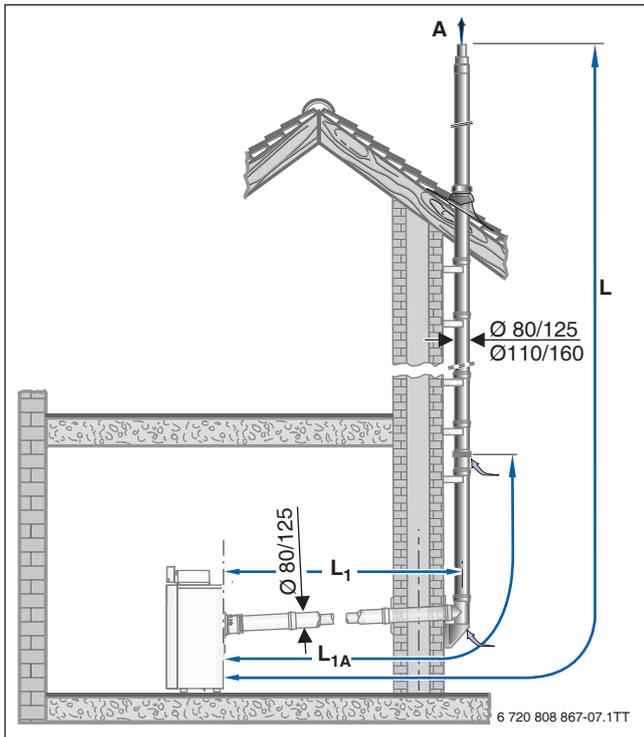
Montagevarianten mit dem Bausatz GAF-K
